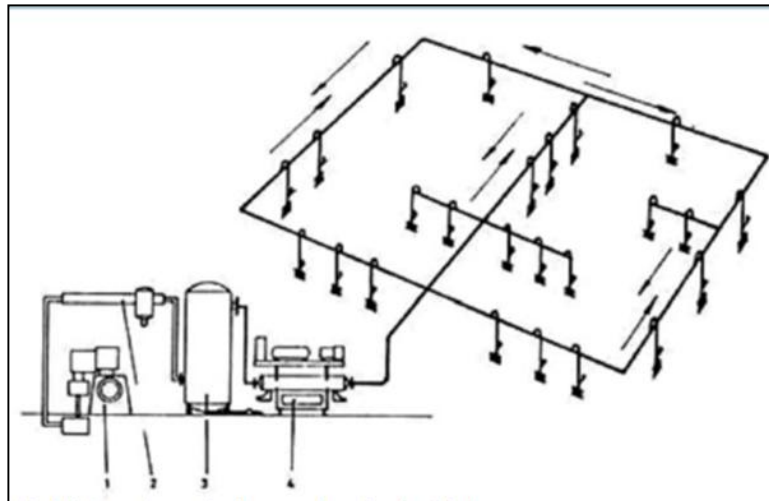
Red Cerrada. Fuente (Belfor II)
